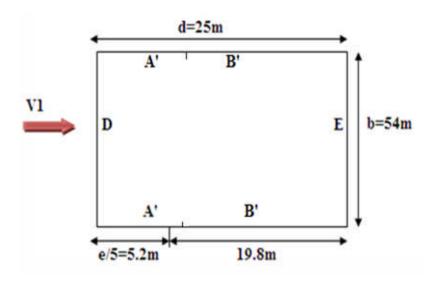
Vue en plan de la paroi verticale de direction Lang-pan.
